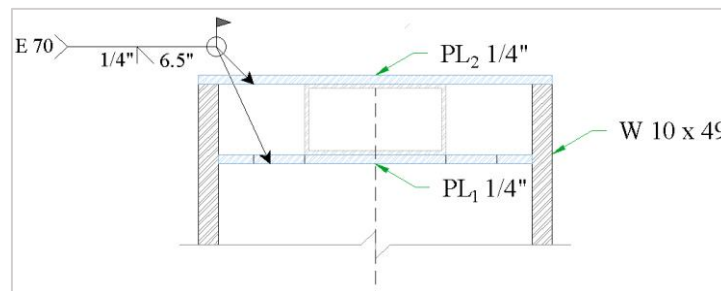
23. Detalle conexión placas PL1 y PL2 con columna.
